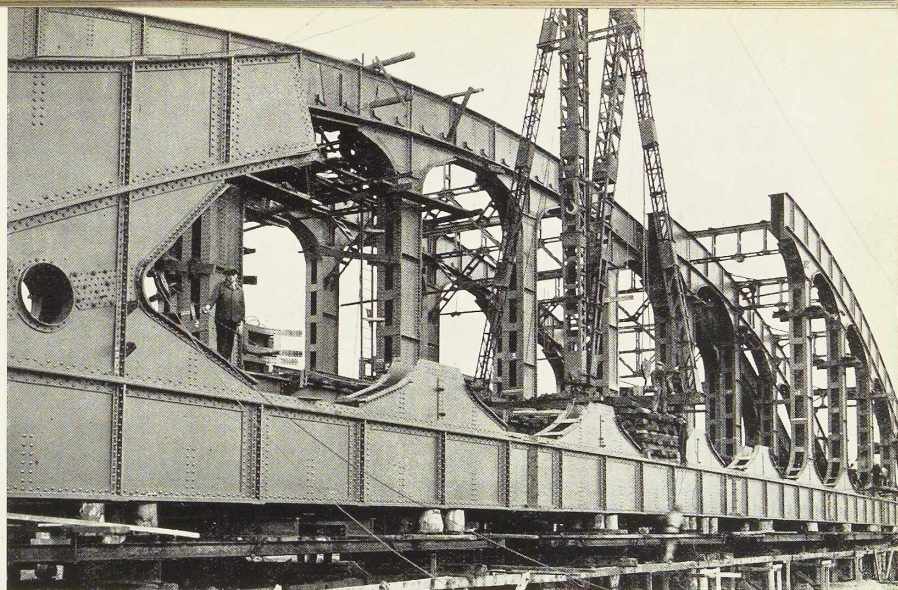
Vue d'enfilade du pont-rail double d'Hérenthals après achèvement du montage. A noter dans le contreventement supérieur, d'une part les entretoises doubles en poutres Vierendeel, d'autre part les bracons formant larges goussets évidés aux extrémités de ces entretoises, qui ont été substitués aux habituelles croix de Saint-André et qui contribuent très efficacement à raidir contre le flambage les brides supérieures des maîtresses-poutres.
